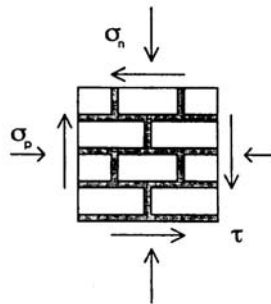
Estado de tensões nos painéis de alvenaria.
